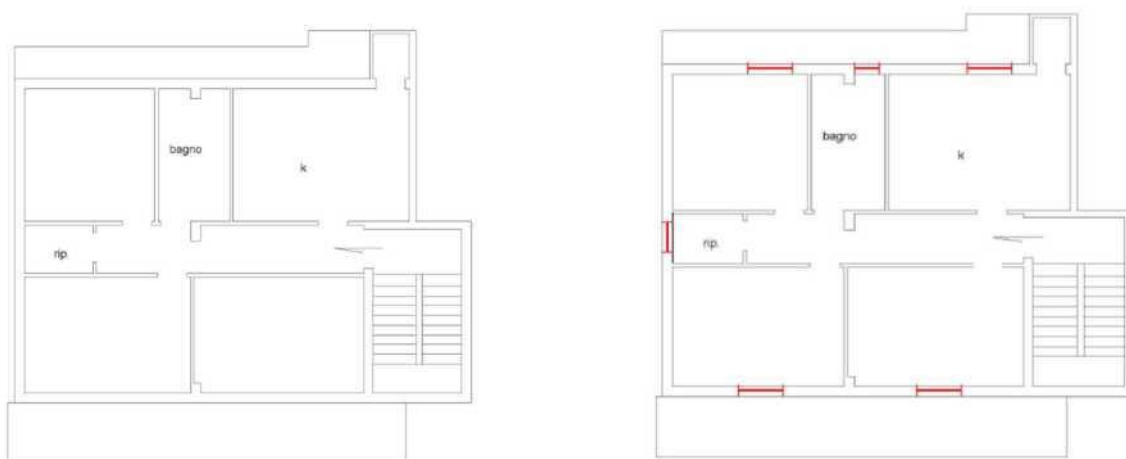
Appartamento piano terzo sub 12 - Confronto tra la planimetria catastale e stato di fatto.
